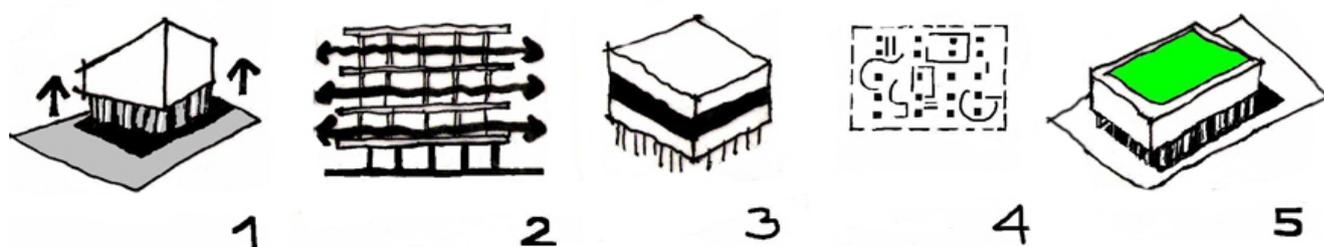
Cinco princípios fundamentais da arquitetura - 1) pilotis, 2) fachada-livre, 3) janelas em fita, 4) planta livre, 5) terraço-jardim. Fonte: ArchiDialog [site].
